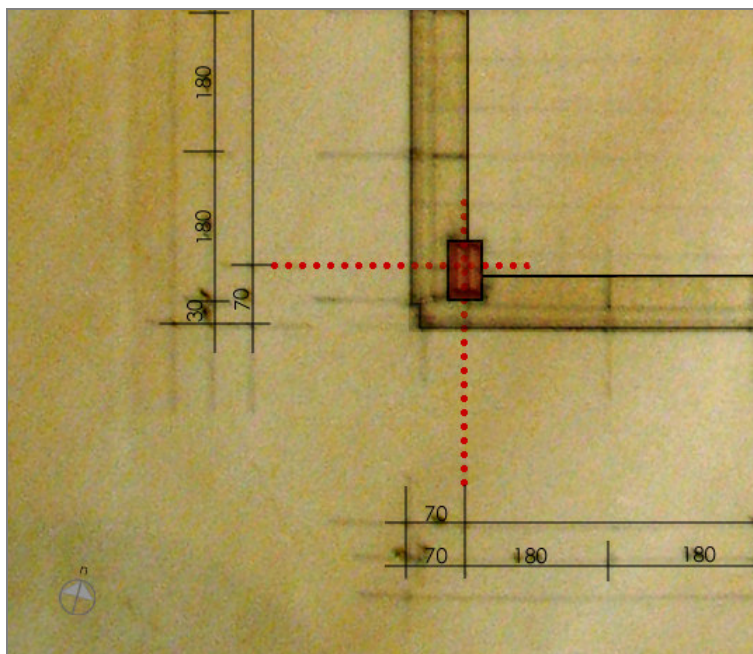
soluzione d'angolo 1960 - stralcio pianta piano tipo quotato
